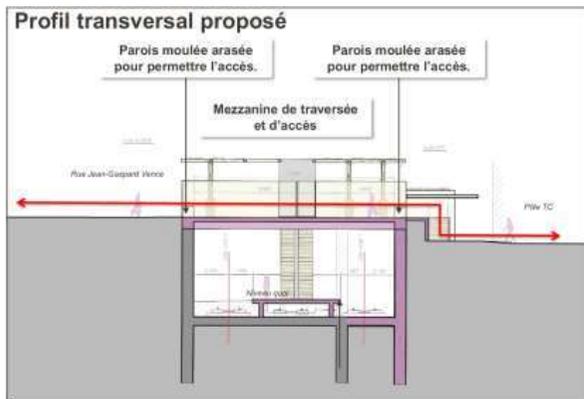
Profil en travers de la halte d'Arenal. La nouvelle paroi est figurée en violet (AREP, 2021)
